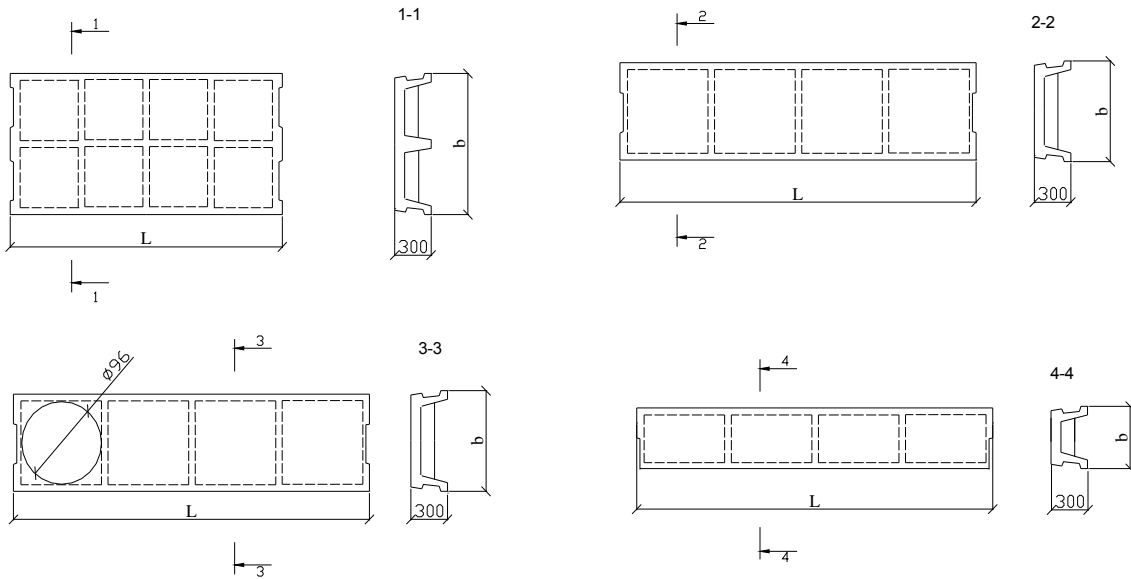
Эскизы конструкций плит перекрытий (начало)
